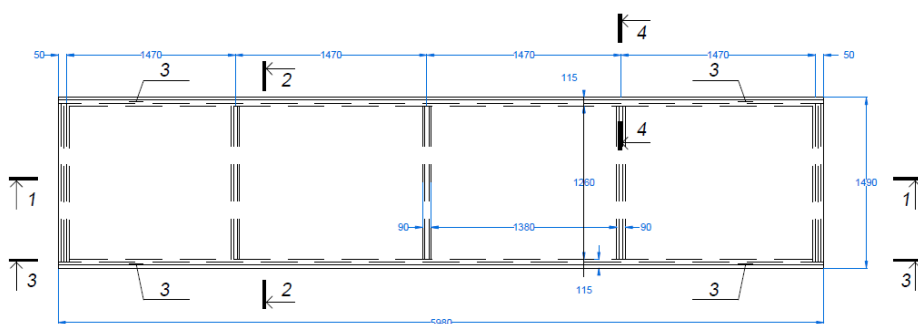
Чертеж ребристой плиты перекрытия, вид сверху
